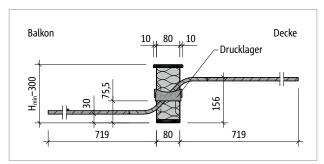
Schöck Isokorb® T Typ QL-V5 bis QL-V6: Produktschnitt
